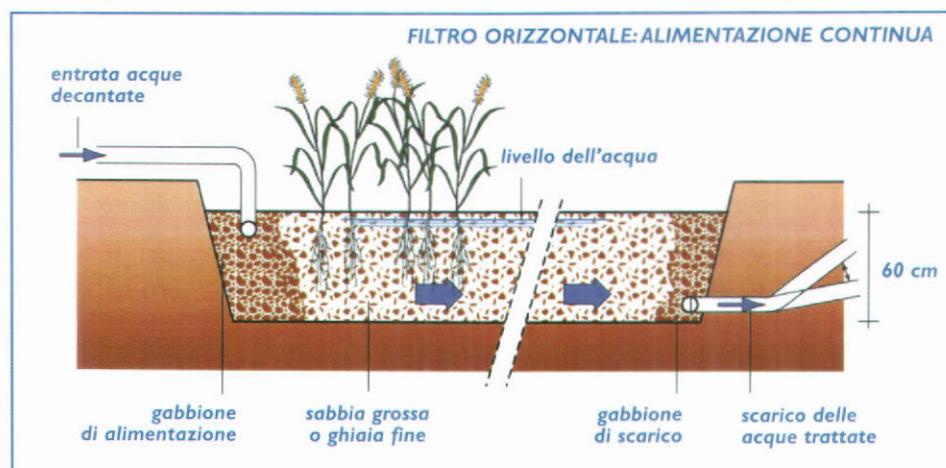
Sezione trasversale di un letto filtrante orizzontale
